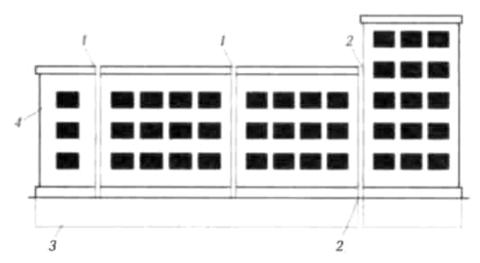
Схемы размещения и конструкции деформационных швов: 1 – температурный шов; 2 – осадочный шов; 3 – фундамент; 4 – стена
